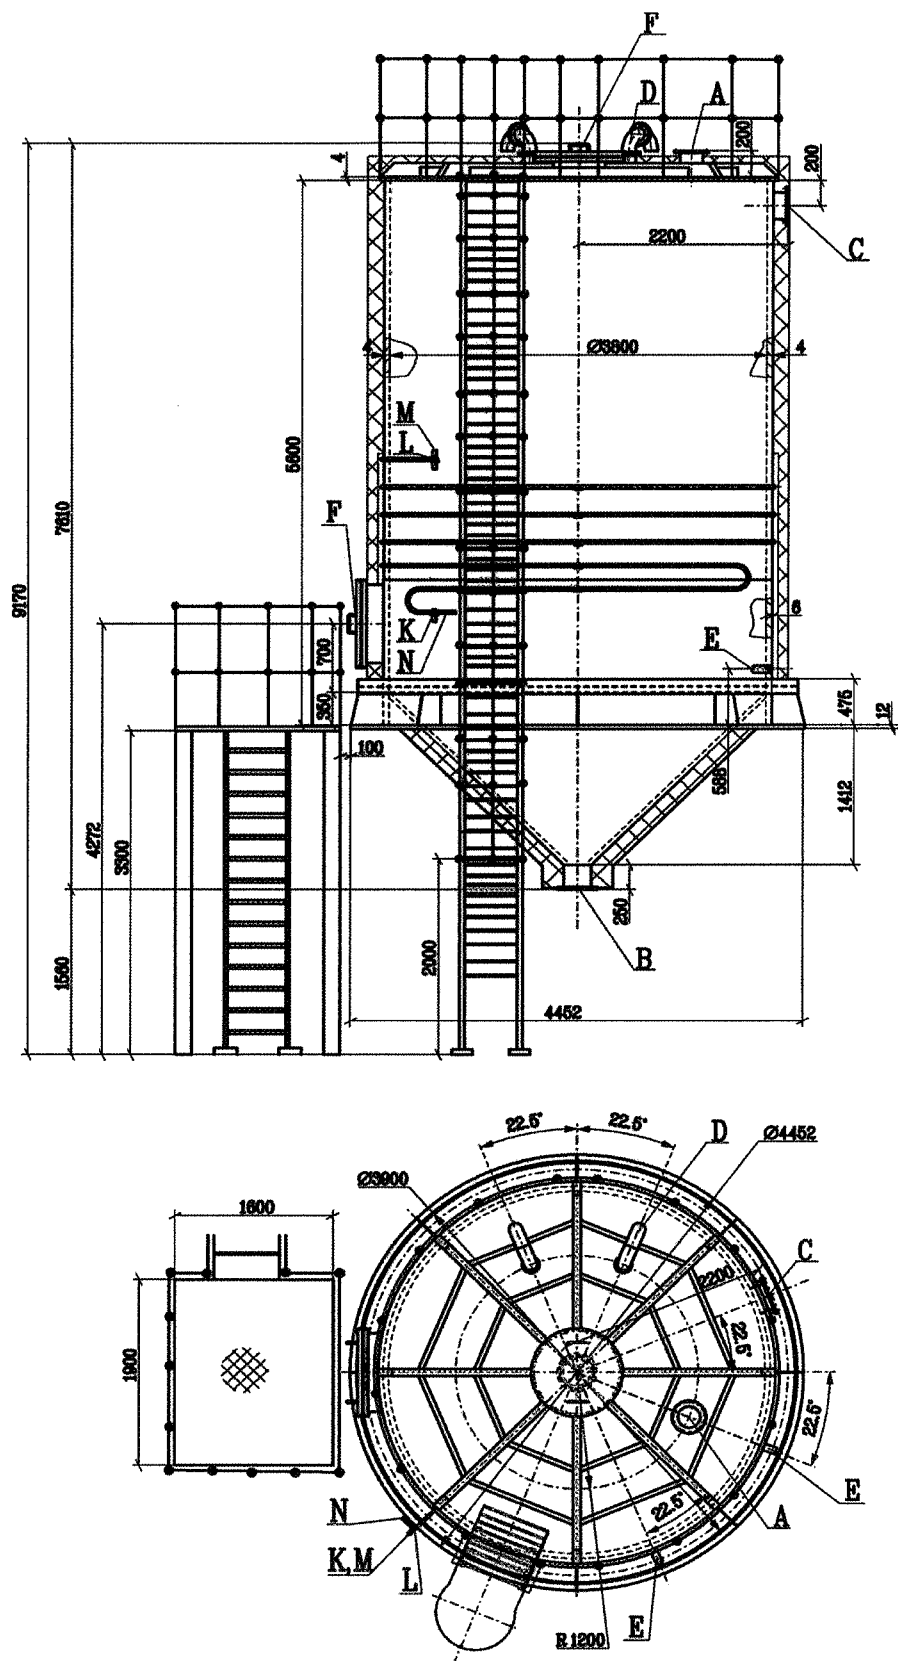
Габаритный чертеж бака осветленной воды GDB70BB001,
